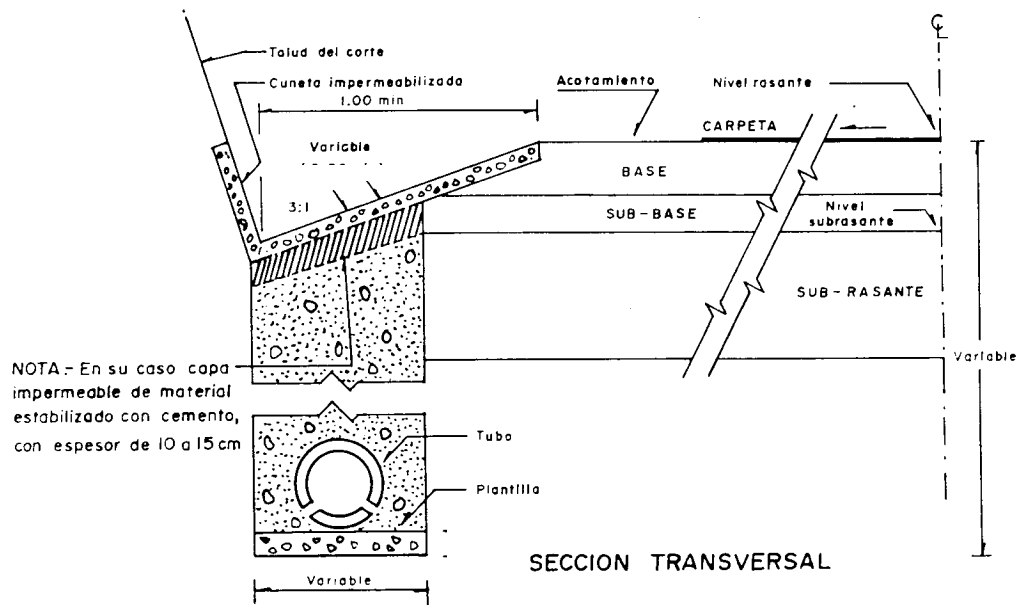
Sección transversal tipo de un subdrén en zanja.
